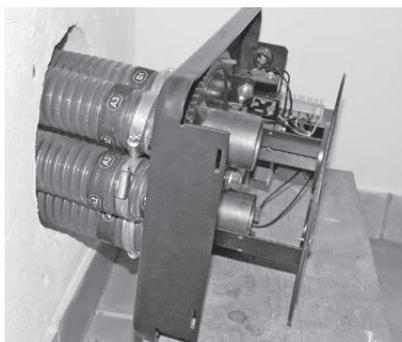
Fissare i tubi flessibili con le fascette di serraggio
